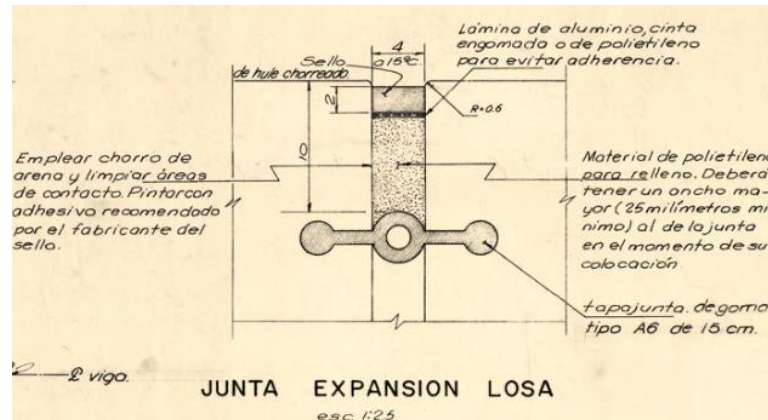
Detalle constructivo de la junta de expansión sobre la Pila 2 según se muestra en los planos originales del puente existente sobre el río Destierro.
